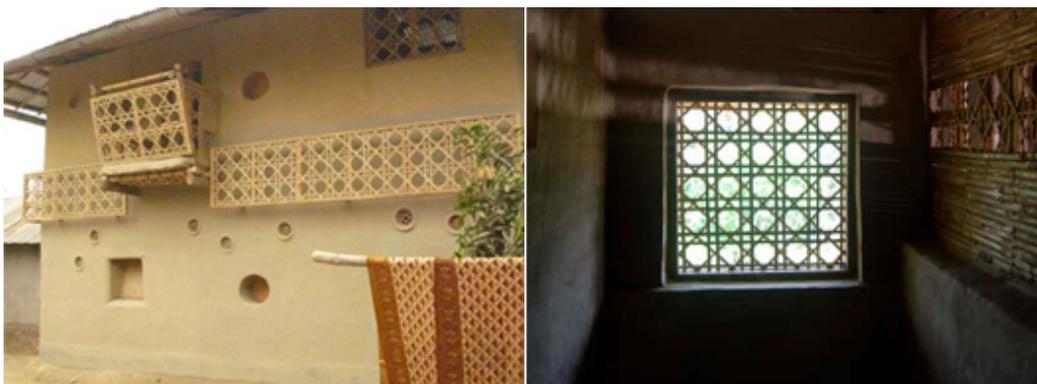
Elementos decorativos y detalles constructivos en entramados de bambú. (Fuente: <http://www.anna-heringer.com/fileadmin/anna/Press/Archfuture.pdf>)
